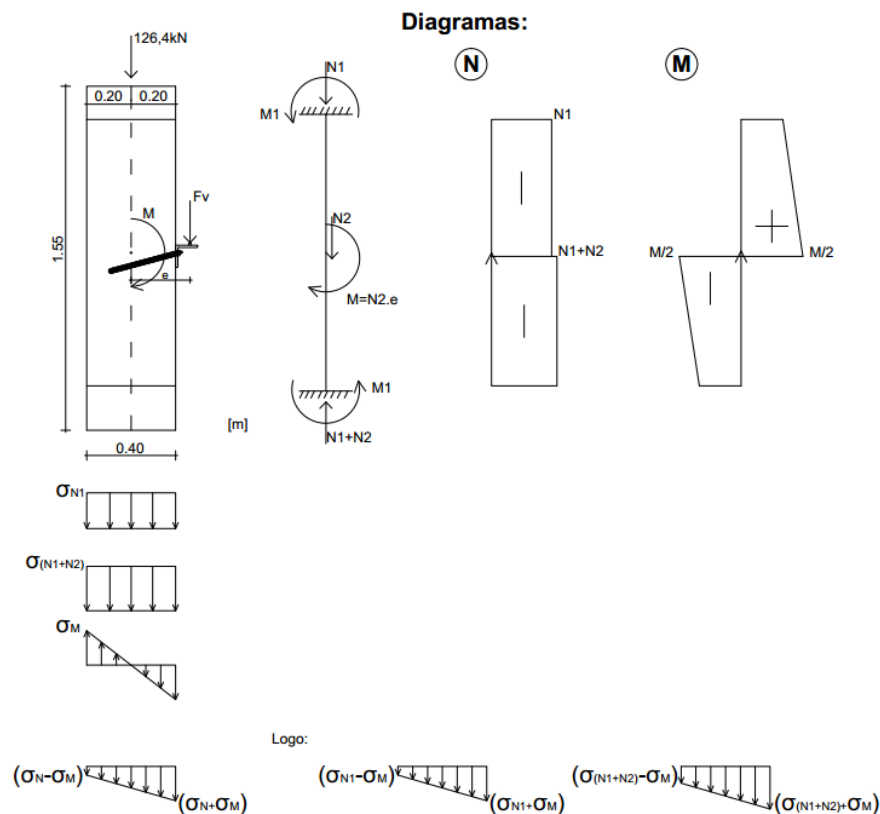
Representação esquemática do cálculo das tensões no ensaio da ligação pavimento/parede.
